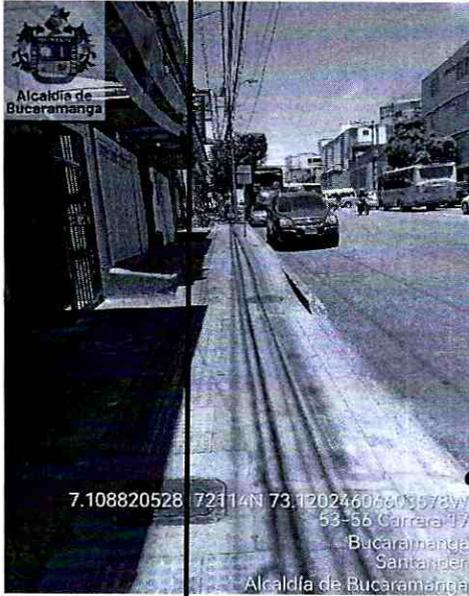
instalación de cámara 1 en la carrera 17 No 53-75 sentido Sur-norte, costado Oriente. Barrio La Concordia.
